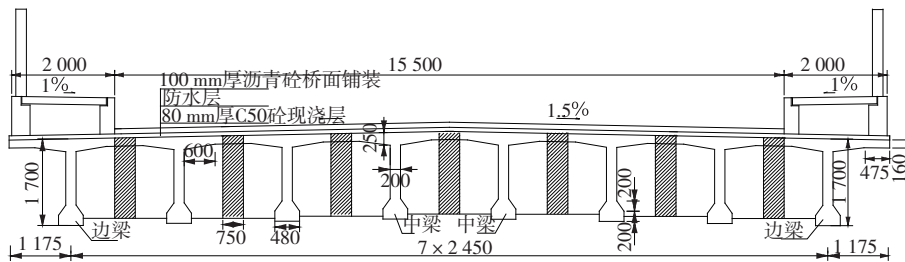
25 m 预应力砼 T 梁跨中断面示意图(单位: cm)
